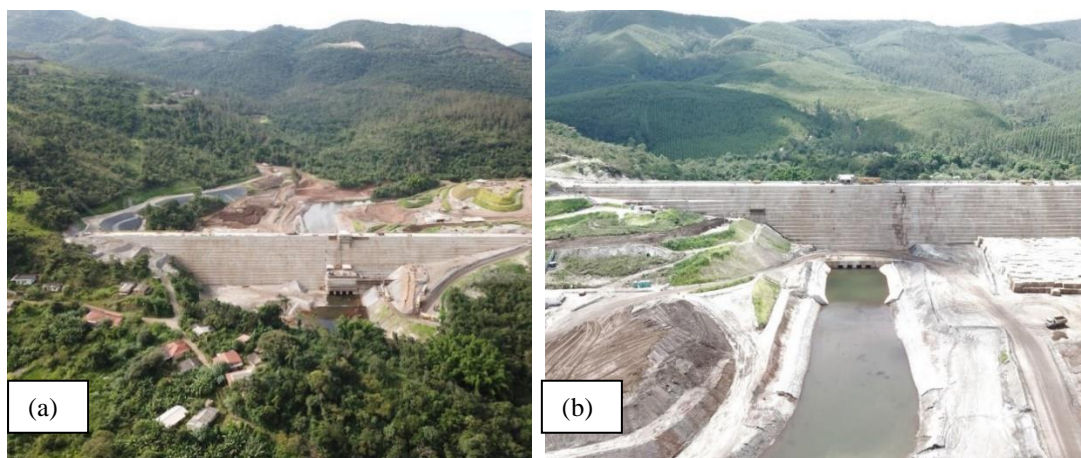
Vista panorâmica da Estrutura de Contenção em CCR
